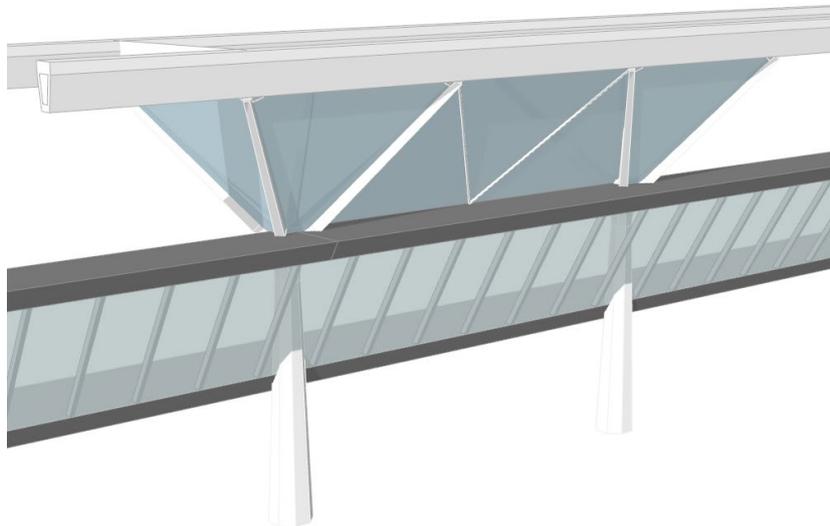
Modello facciata EWS-103 Facciata inclinata ETFE
